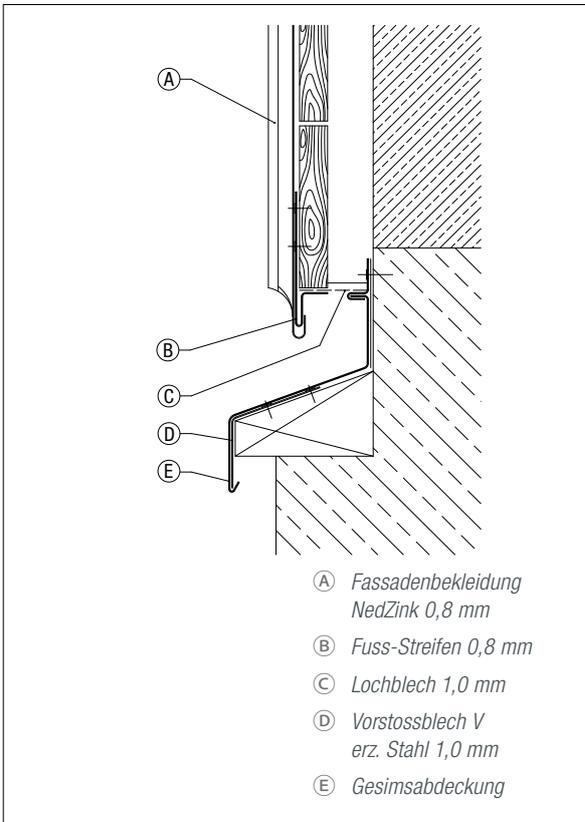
Fassadenanschluss Winkelstehfalz an Fensterbank
